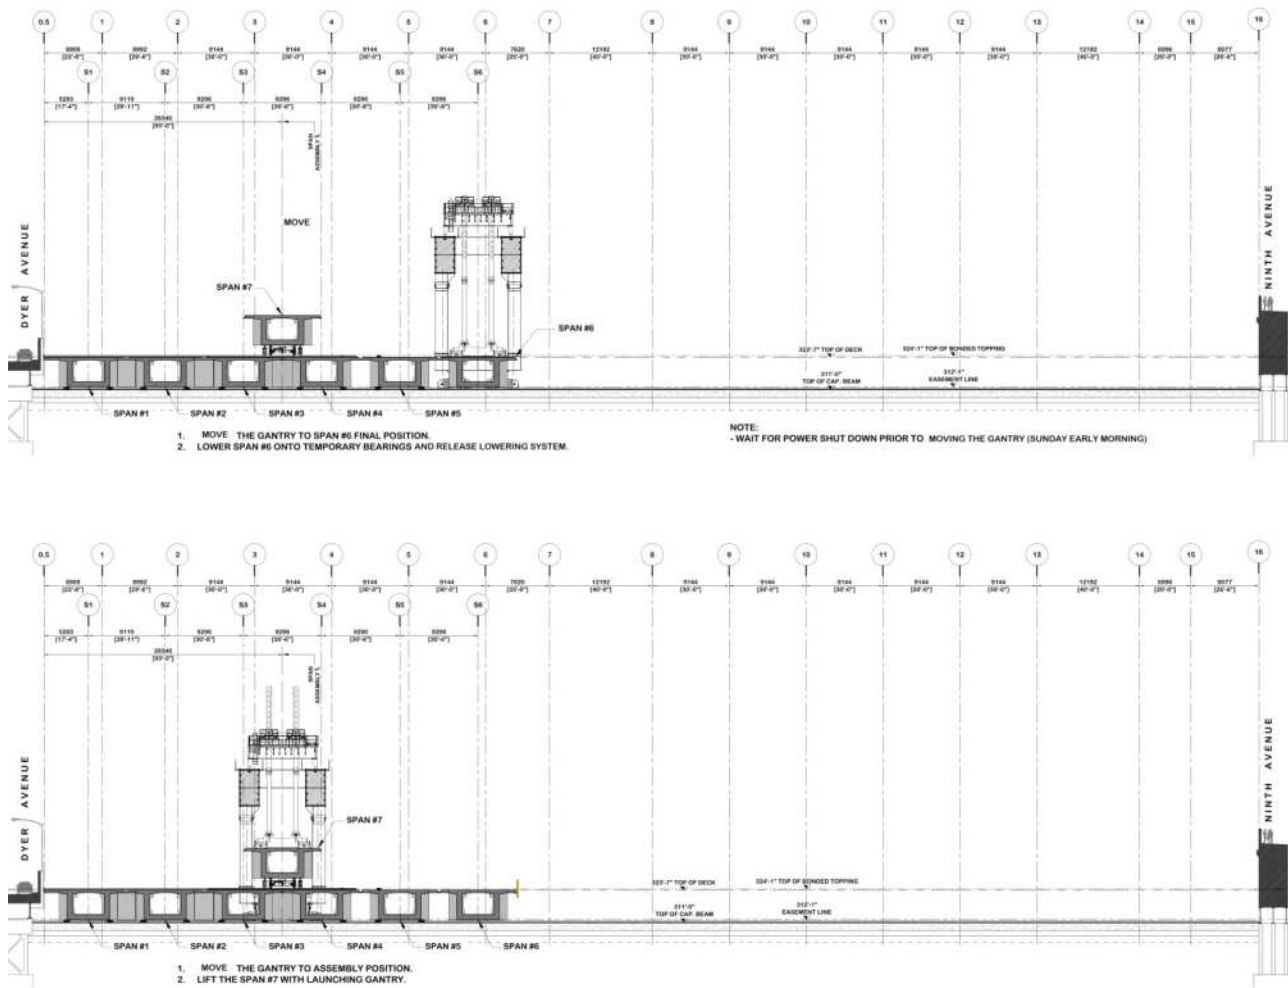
Schema di traslazione della campata dallo stoccaggio temporaneo alla posizione finale
